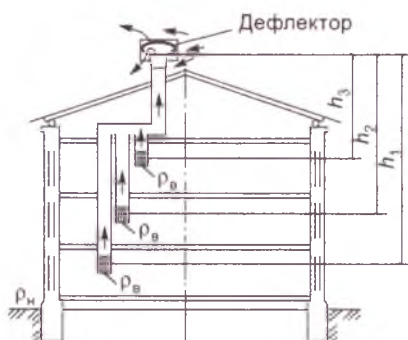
Схема вытяжной естественной канальной вентиляции
